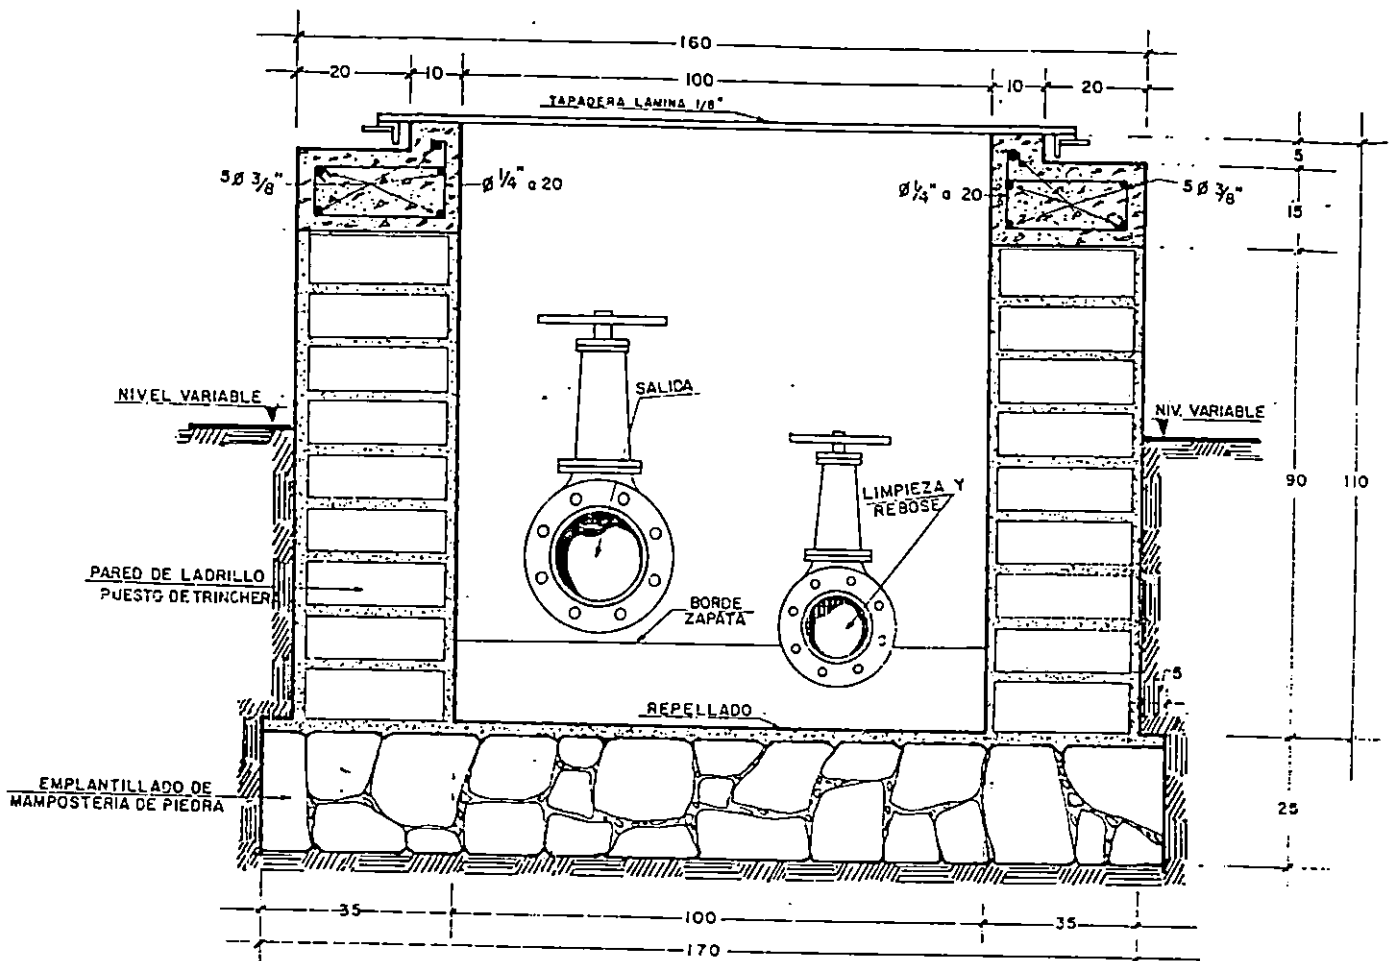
(C) Detalles de la Tubería de salida y de la Tubería de Limpieza
